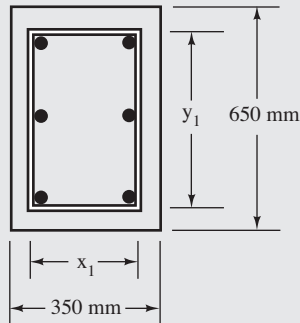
Sección transversal de la viga del Ejemplo 15.2.
